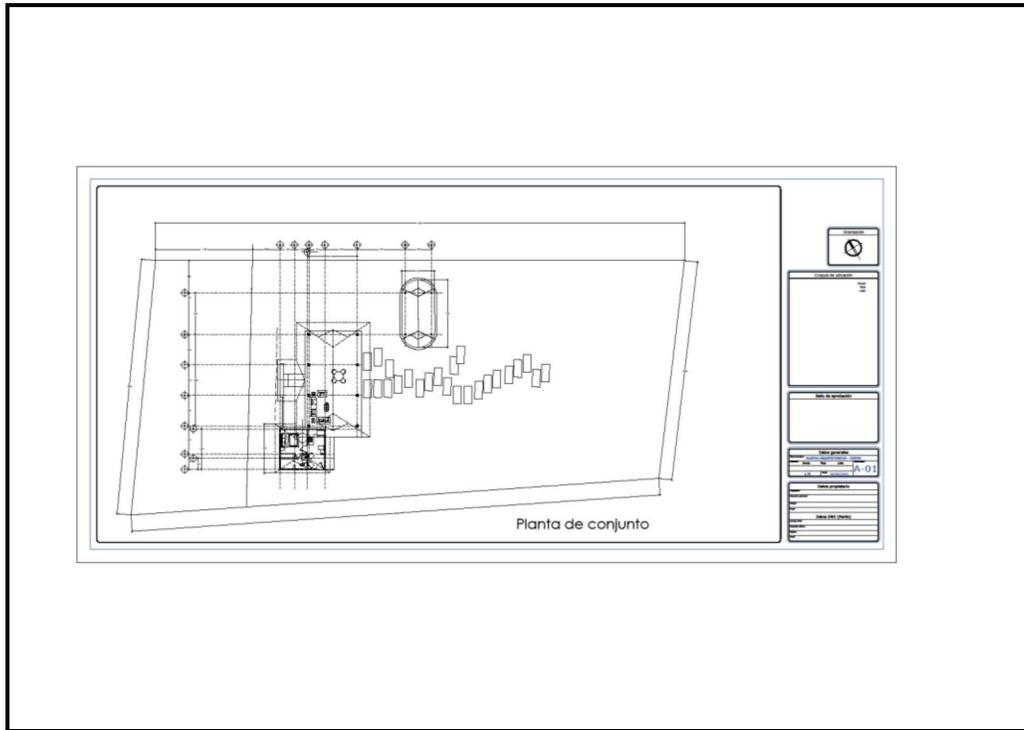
Proyecto “Casa Habitación Soliman”. Planta de Conjunto (Casa y palapa)
